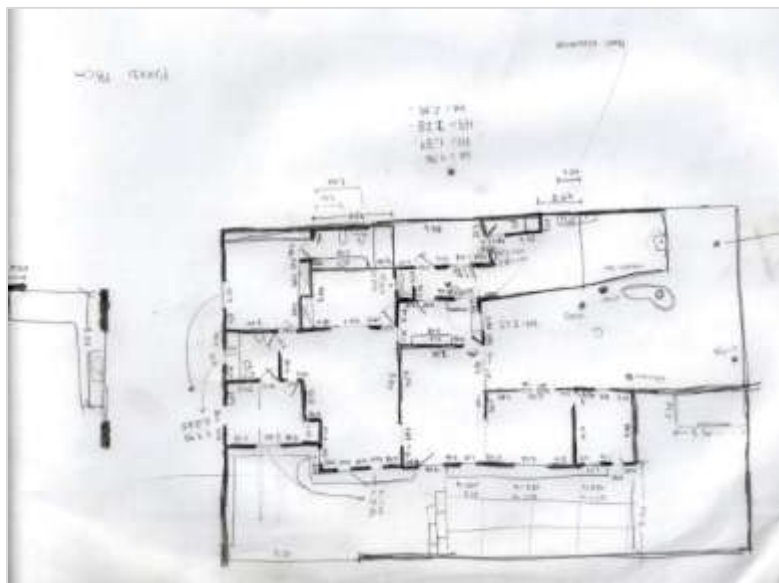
Levantamiento a mano alzada Vivienda Sr. Gabriel Arguello. Fuente: Elaboración Propia.
